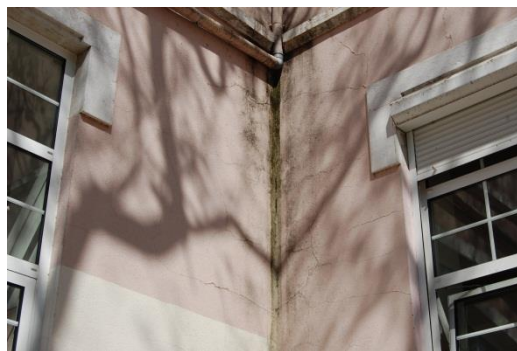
Pormenorização de manchas esverdeadas no revestimento aplicado na Fachada principal [Fonte: Autora, Data:18-05-2016]
